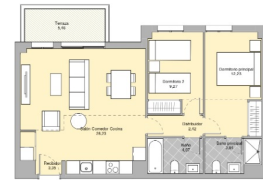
Planta de la tercera planta del Bloque 3. Se trata de un plano de referencia que muestra la distribución general de la planta. No se debe utilizar para fines de construcción o para la obtención de precios. La información contenida en este plano es meramente orientativa y no debe utilizarse para la obtención de precios. La información contenida en este plano es meramente orientativa y no debe utilizarse para la obtención de precios. La información contenida en este plano es meramente orientativa y no debe utilizarse para la obtención de precios.
